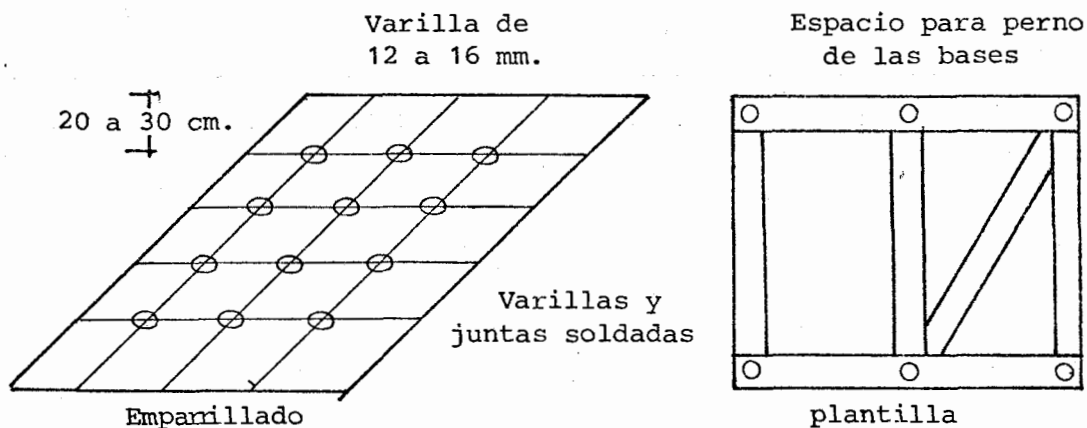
Detalle del emparillado y plantilla que se usaron en la instalación entre la maquinaria y su fundación
